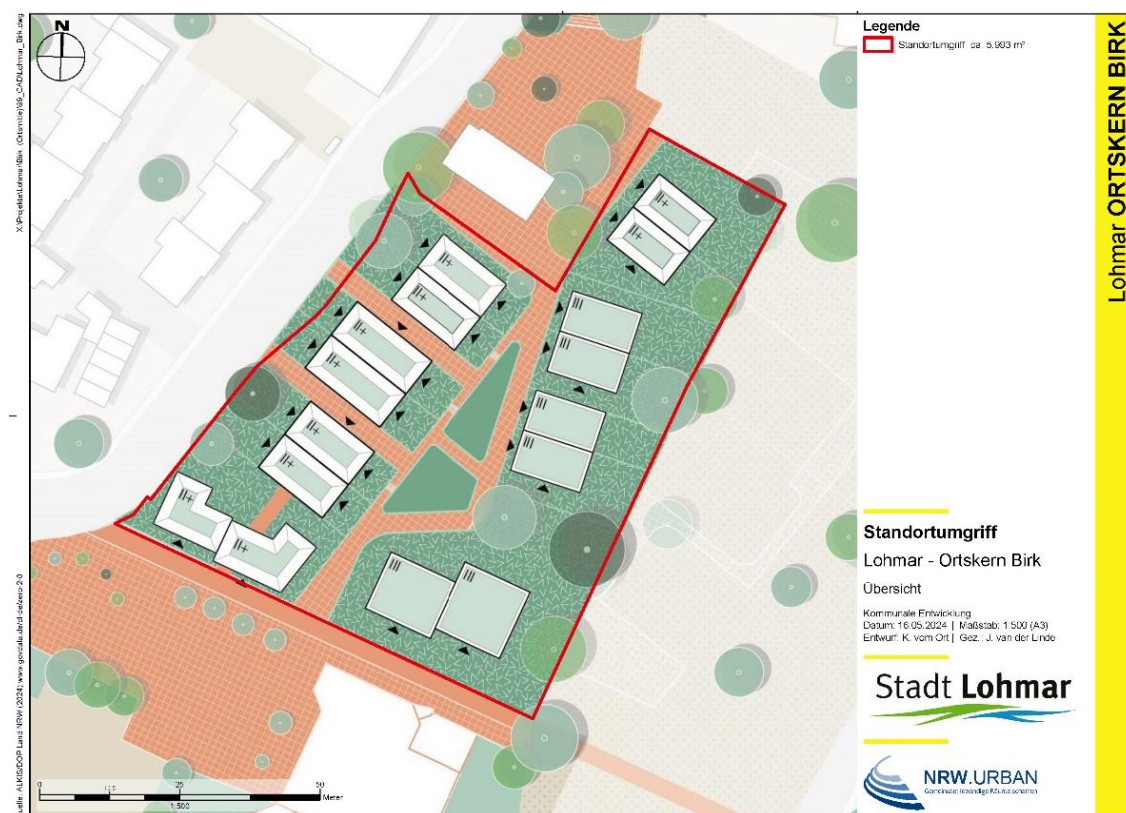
Markierung des Plangebietes im städtebaulichen Vorentwurf (*must*).
